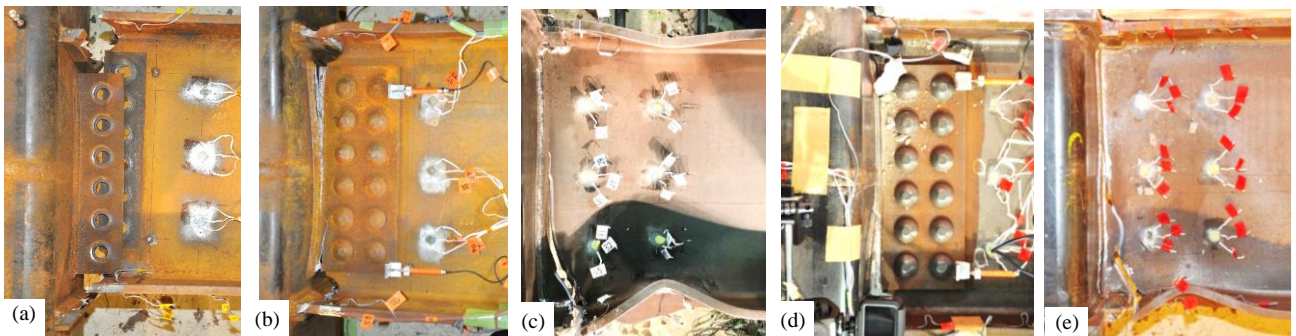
実験後の接合部 : (a) 試験体 1、(b) 試験体 2、(c) 試験体 3、(d) 試験体 4、(e) 試験体 5
